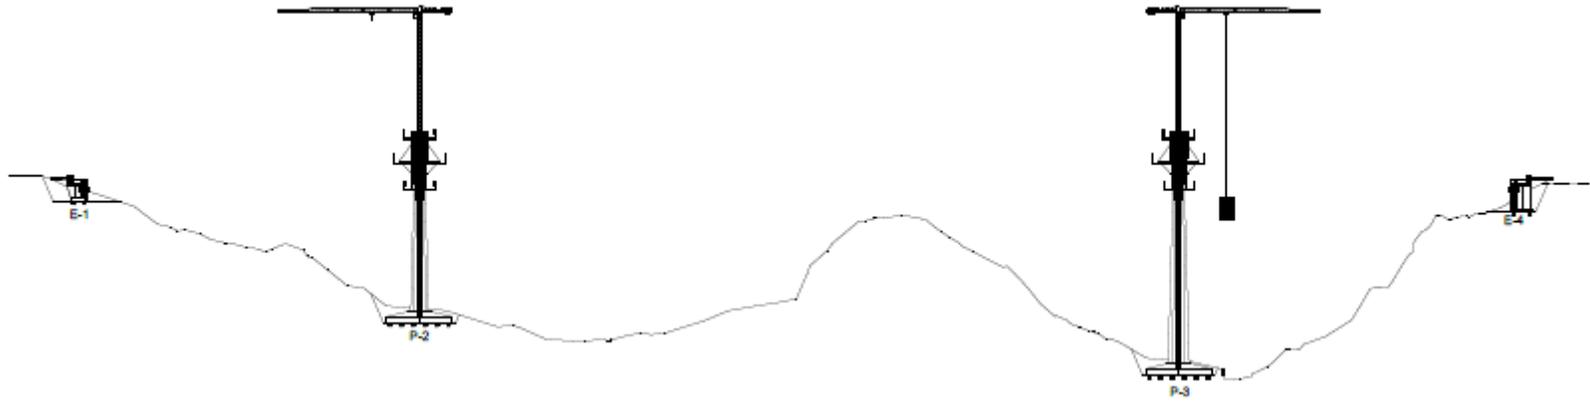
Fase 4: Colocación de módulos metálicos de tirantes y colocado de concreto exterior de los mismos
